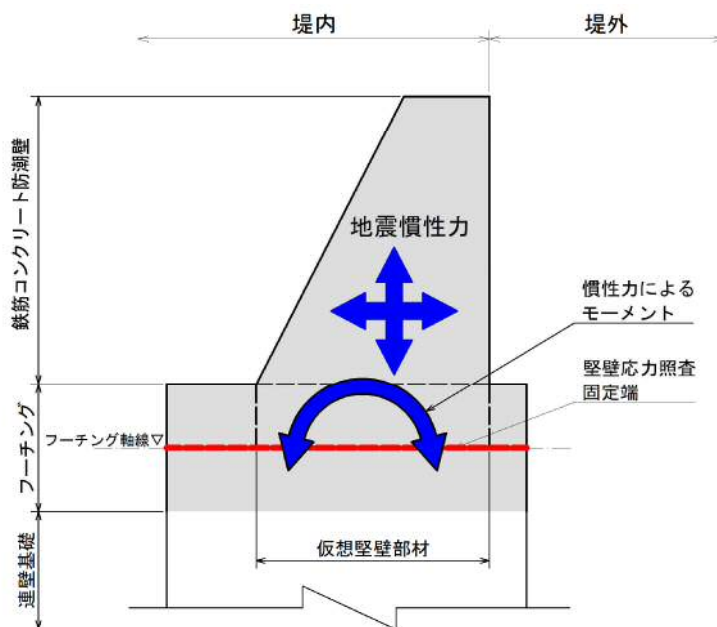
鉄筋コンクリート防潮壁のモデル概念図
